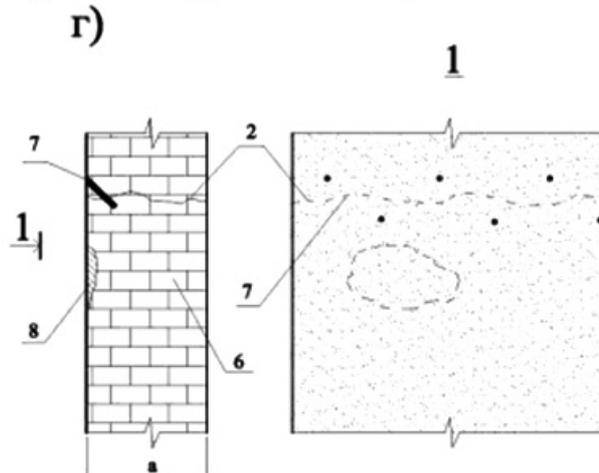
Трещины, полости (пустоты) в кирпичной, каменной или бетонной конструкции:
